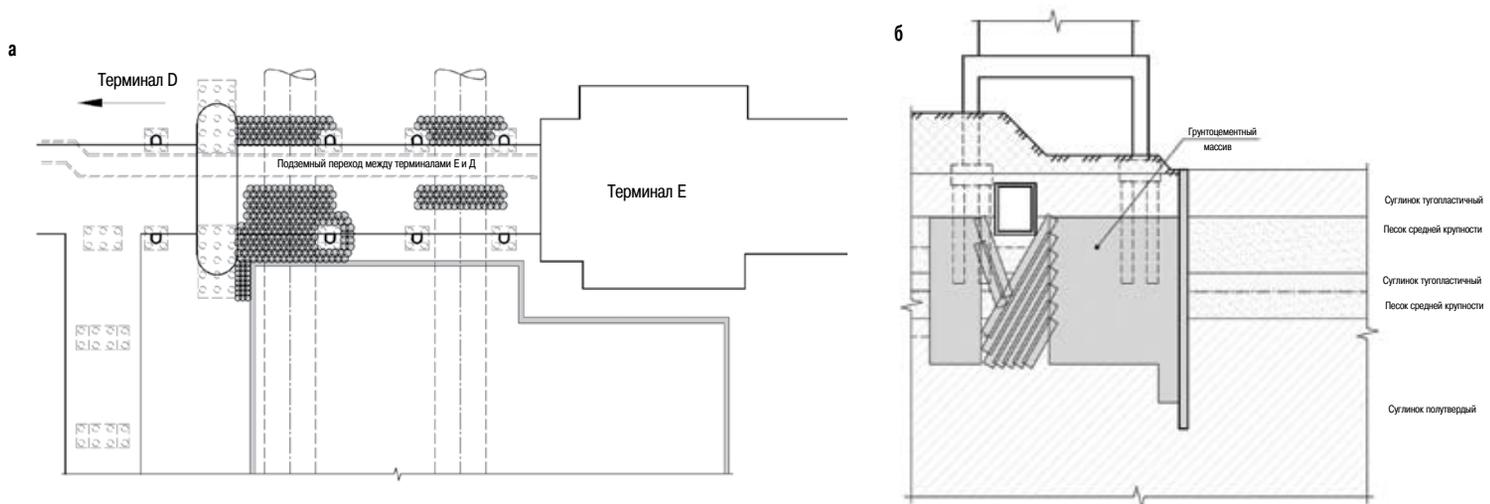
План (а) и разрез (б) пригруза тоннеля в зоне приемного котлована
